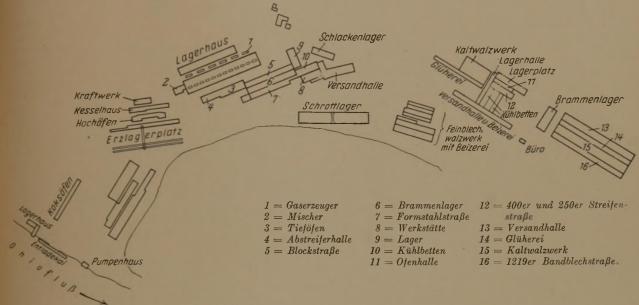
Lageplan der Anlagen der Weirton Steel Company.
